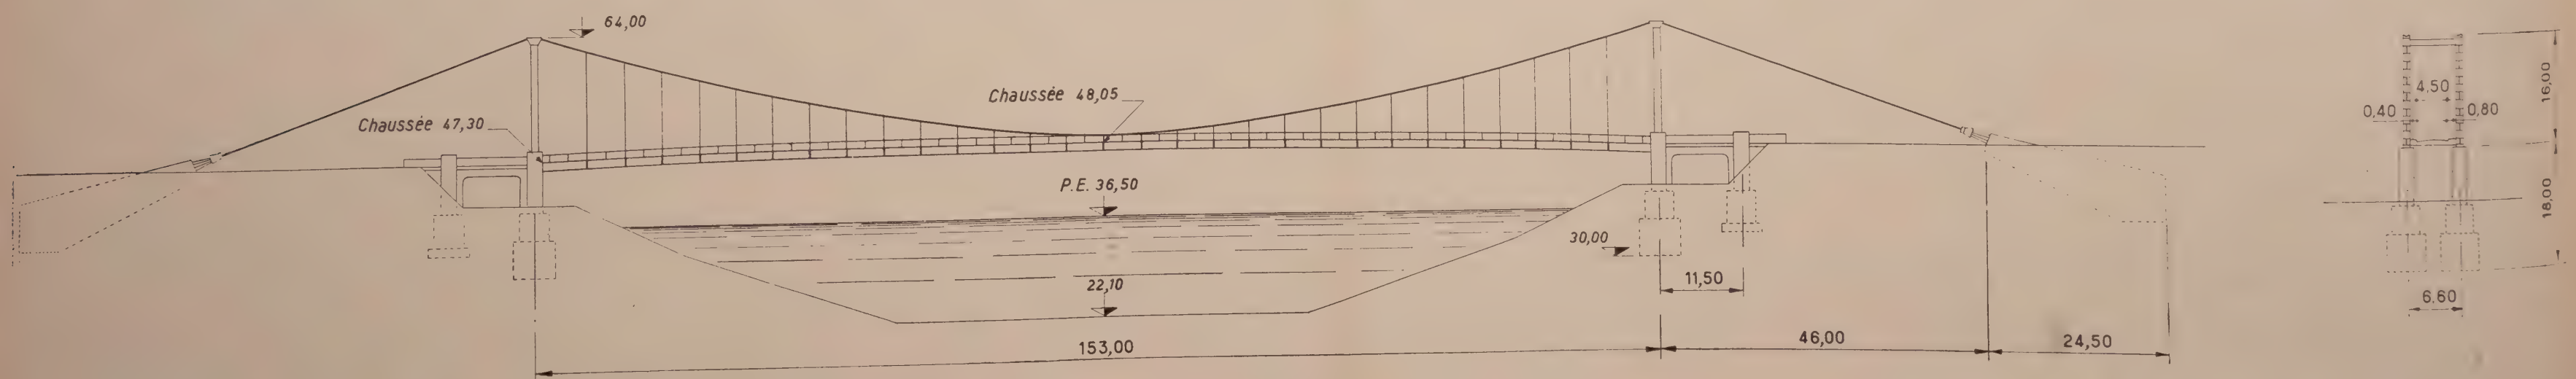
Pont du C. D. 44. Élévation et coupe transversale.
